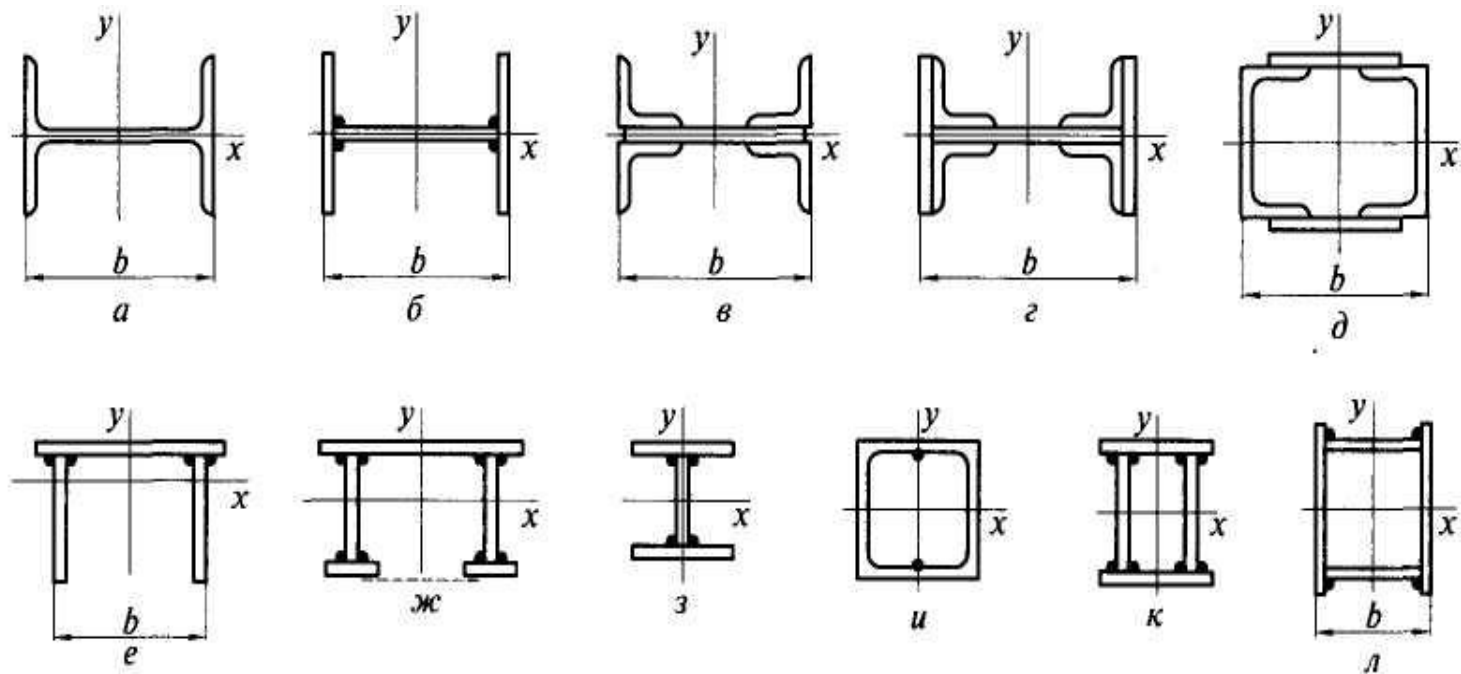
Типы сечений стержней тяжелых ферм:
